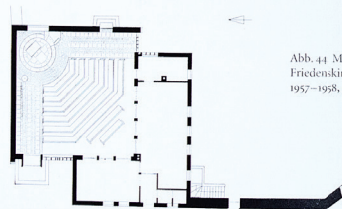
Manching, Friedenskirche, 1957–1958, Grundriss
